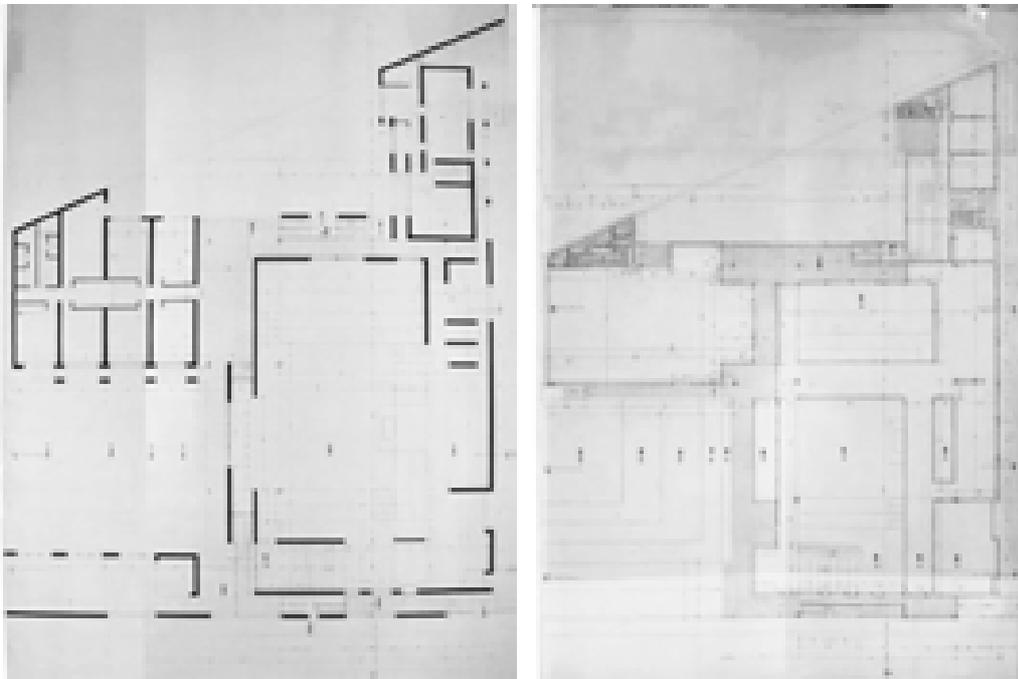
SX, Pianta, +1.60 –08/12/1981 (AABS-1996.466)
